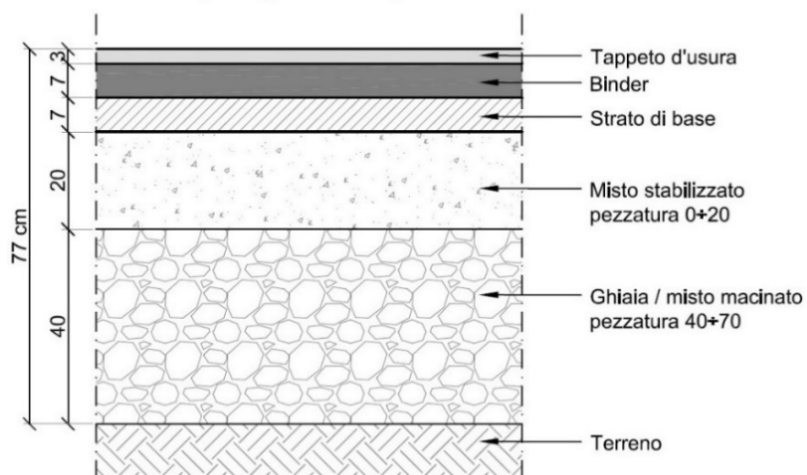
Particolare tipologico delle pavimentazioni in asfalto
